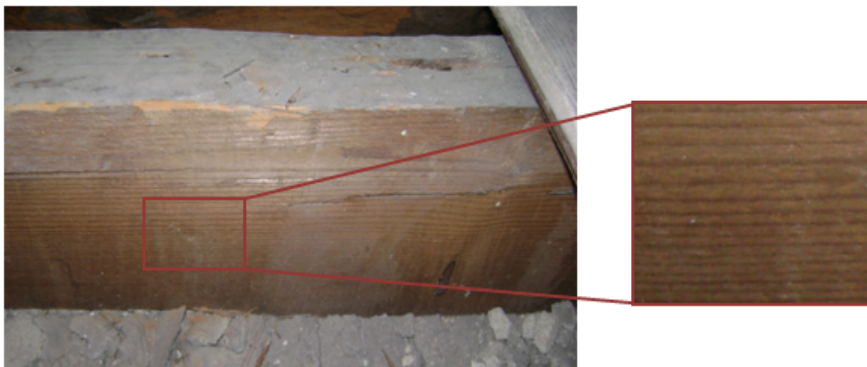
Inclinação do fio (Viga 9 do pavimento)
